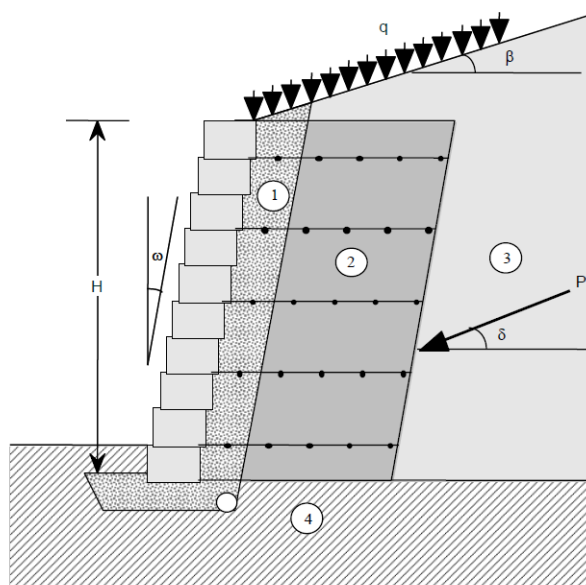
Схема армогрунтовой подпорной стенки. 1 дренажный слой. 2 армированный грунт. 3 удерживаемый грунт. 4 основание.
